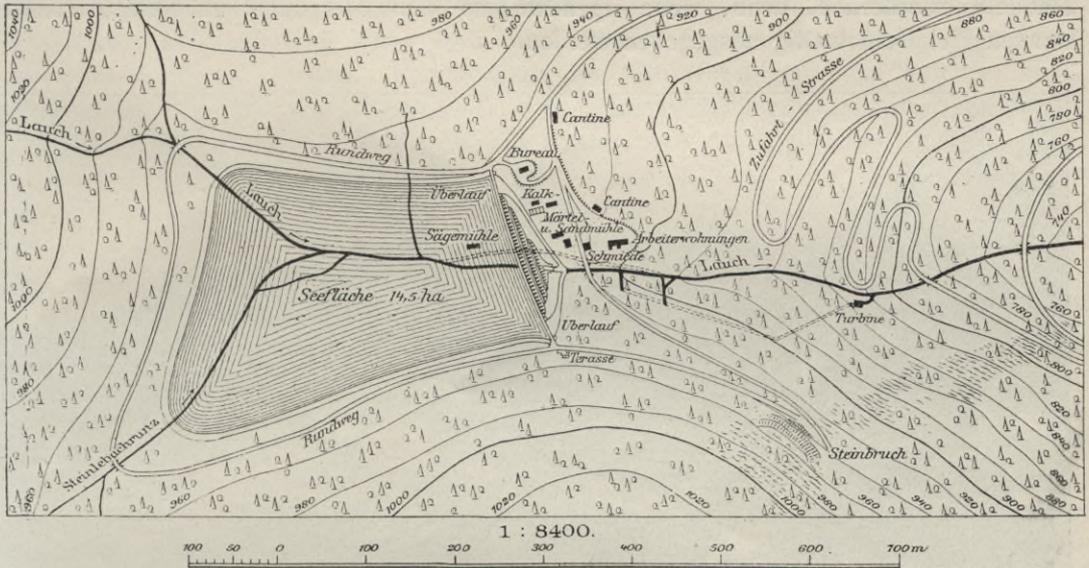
Lageplan der Baustelle des Lauchenseeweiher.
